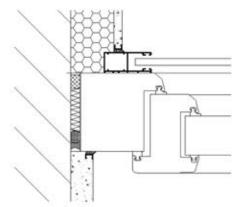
Anschlussdetail mit Führungsschiene A3 - R
